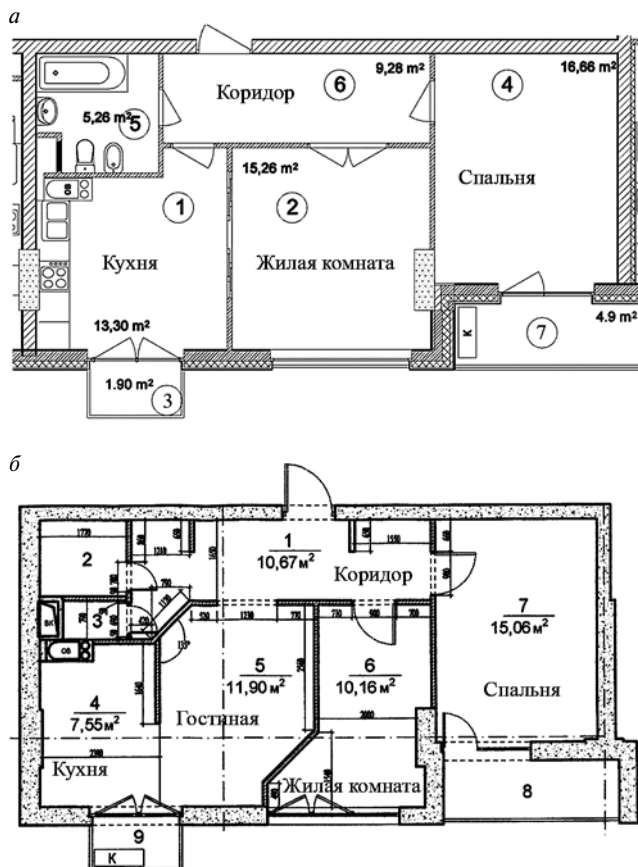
Проект перепланировки двухкомнатной квартиры: а – план квартиры до перепланировки; б – план квартиры после перепланировки. Увеличено количество жилых комнат, общий санузел разделен на туалет и ванную комнату
